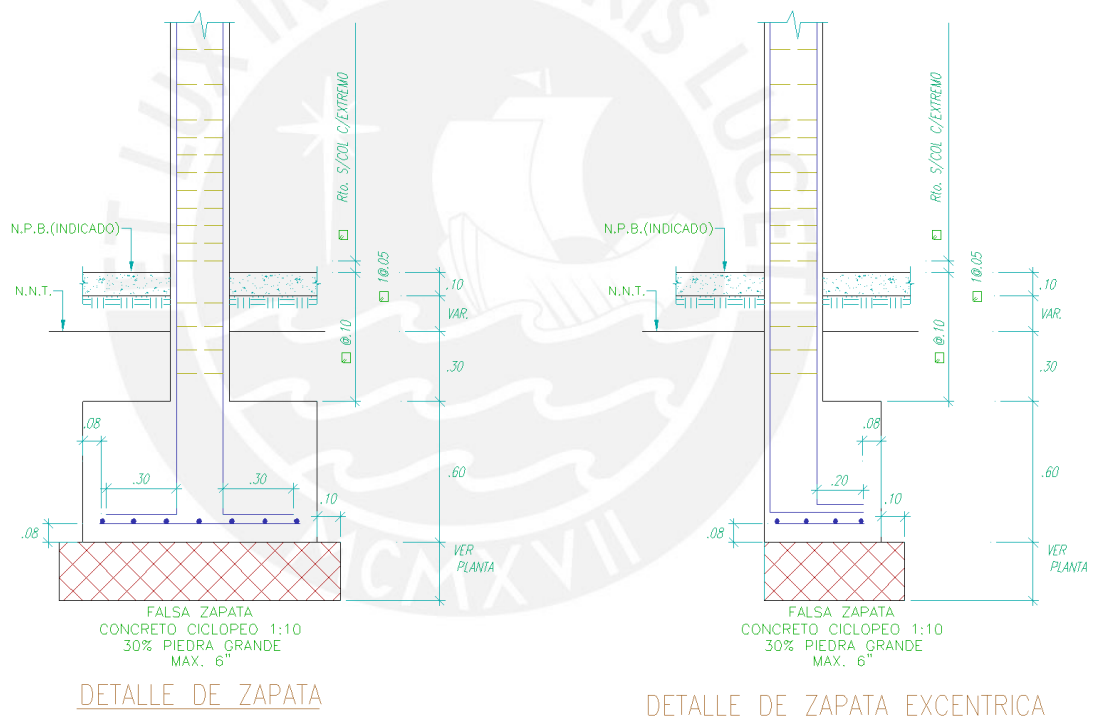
DETALLE DE LONGITUD DE ANCLAJE PARA VARILLAS LONGITUDINALES QUE LLEGAN A LA CIMENTACIÓN.
